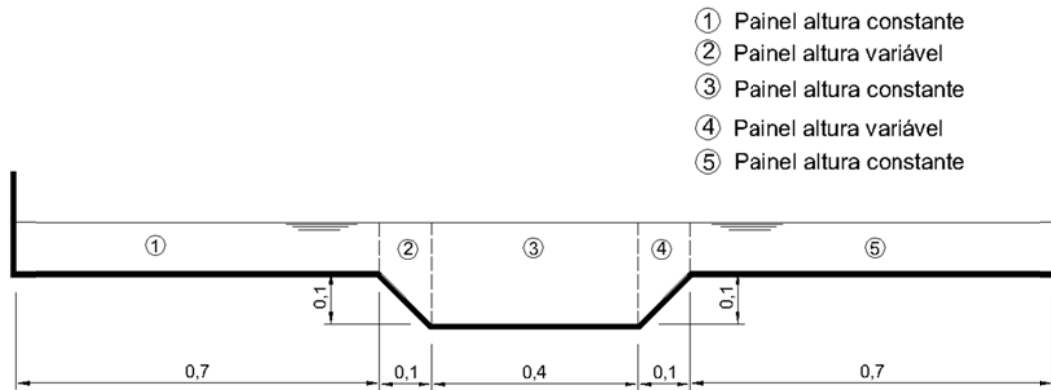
Divisão lateral da Secção transversal do CVC para aplicação SKM
